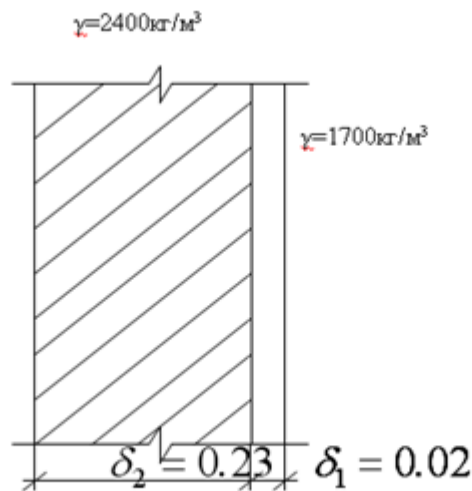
Розрахункова схема зовнішньої стіни із керамзитобетону
